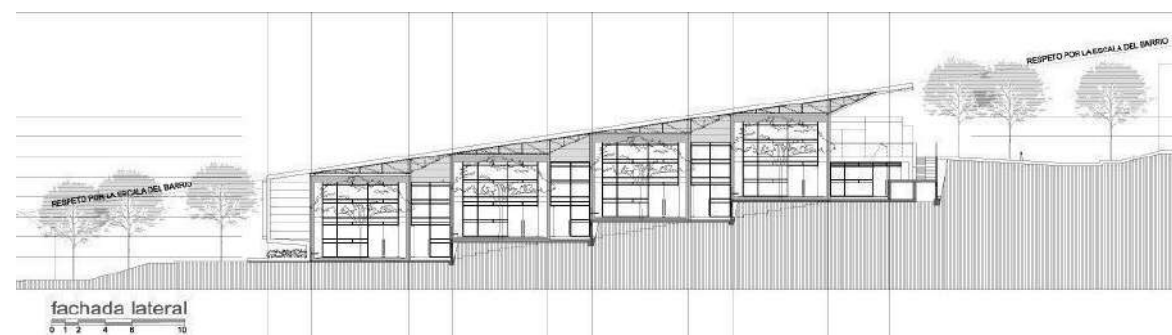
Elevación fachada Sur Parque Biblioteca Jorge Luis Arroyave
